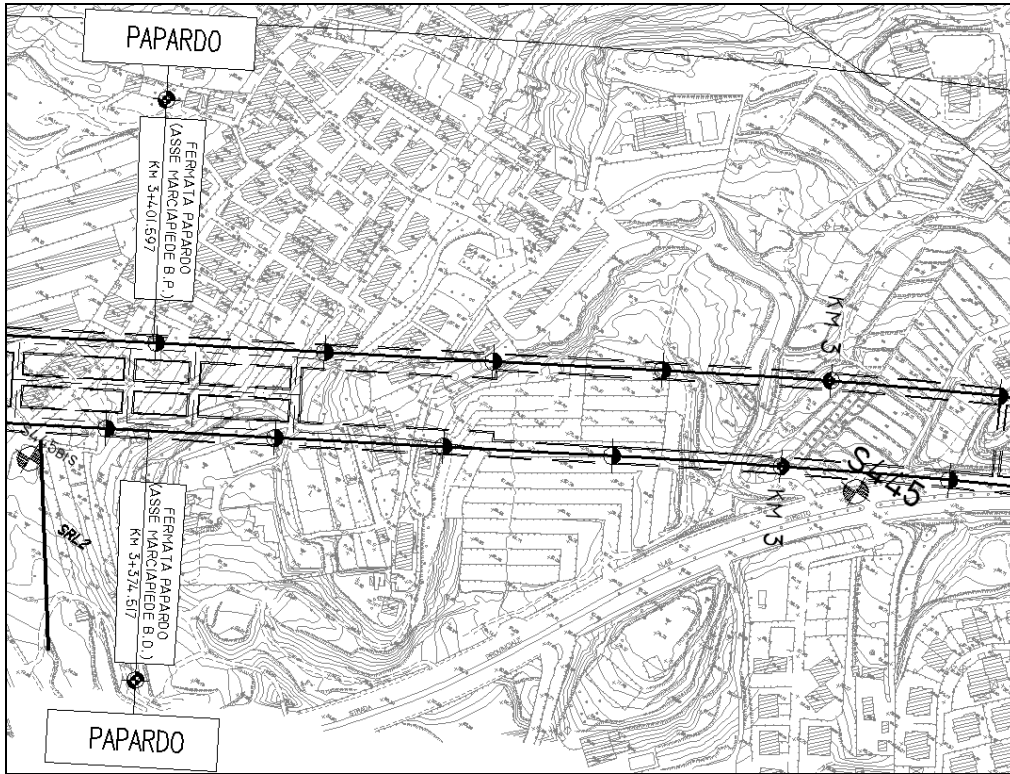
Stralcio planimetrico con posizionamento dei sondaggi
